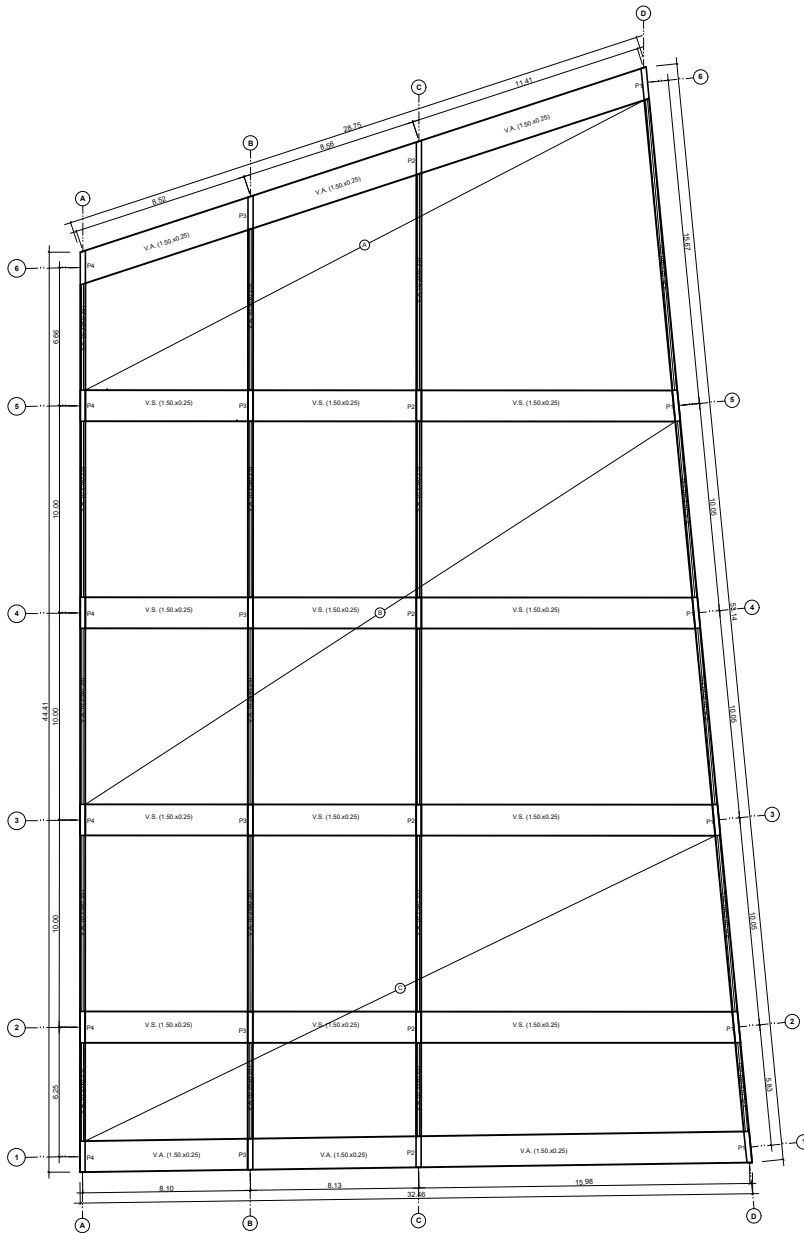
Planos estructurales - cimentación (ampliación)
